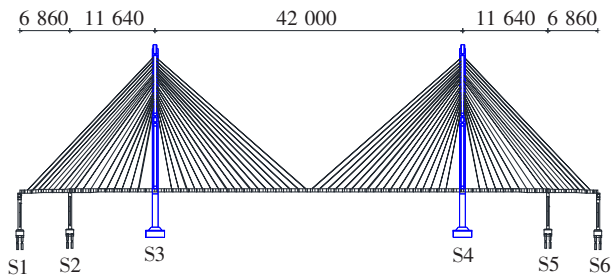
鄱阳湖二桥立面布置示意图(单位:cm)
